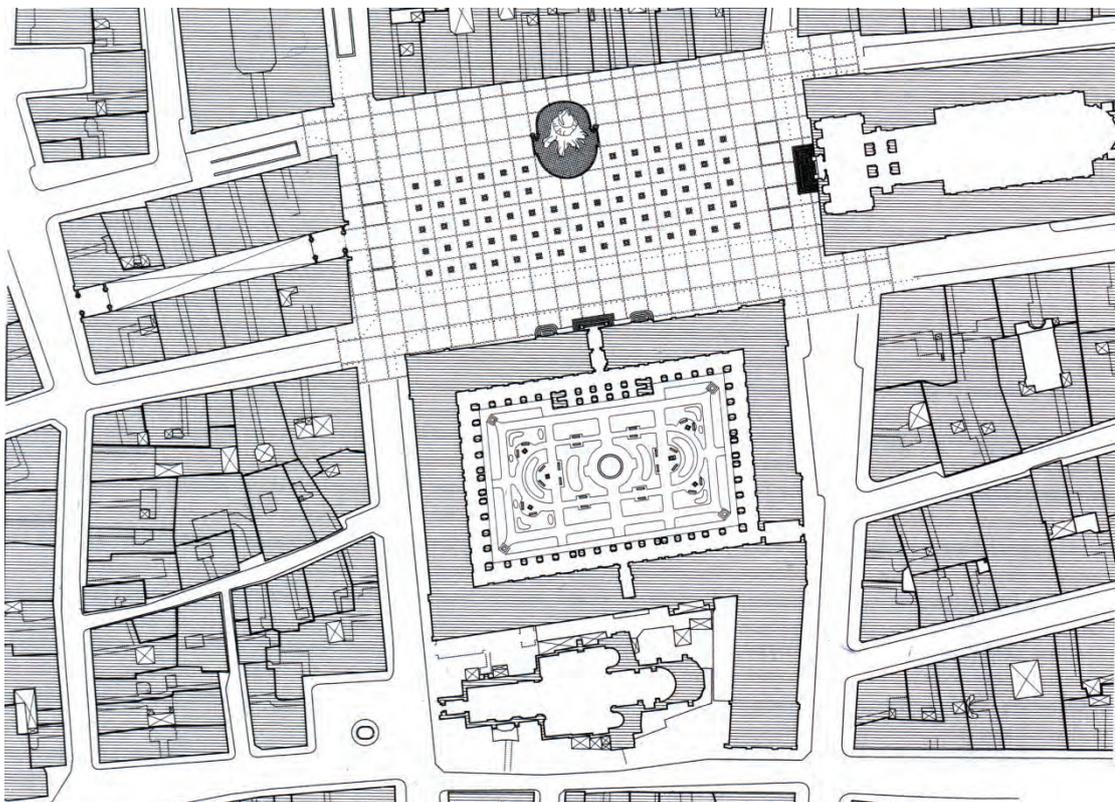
Place des Terreaux mit Umgebung, Lageplan
